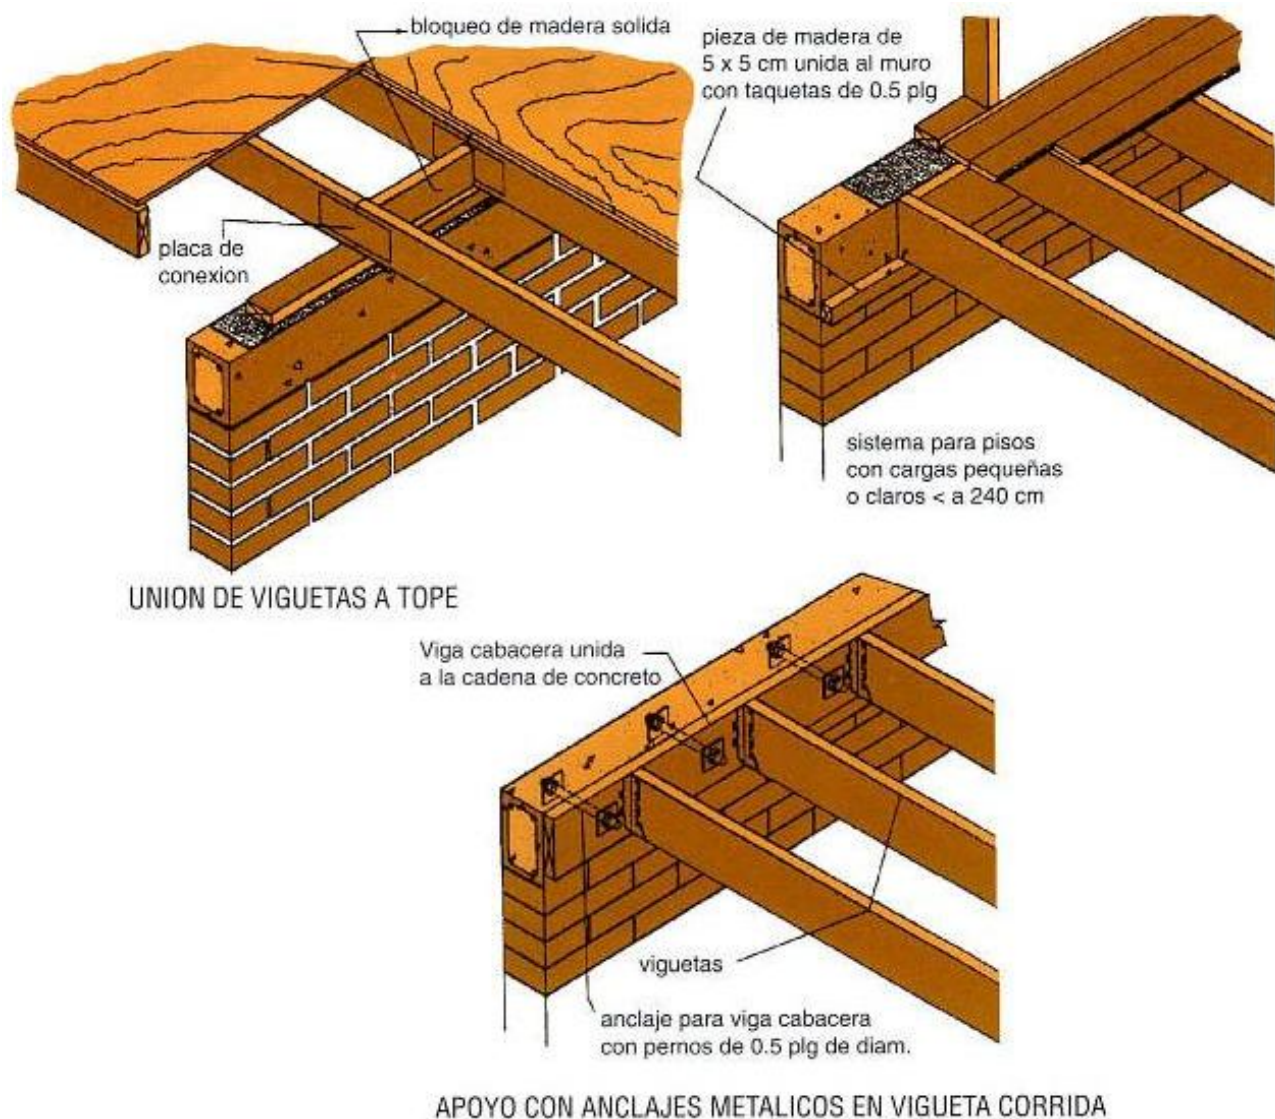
Apoyo de Viguetas sobre Muros de Mampostería
